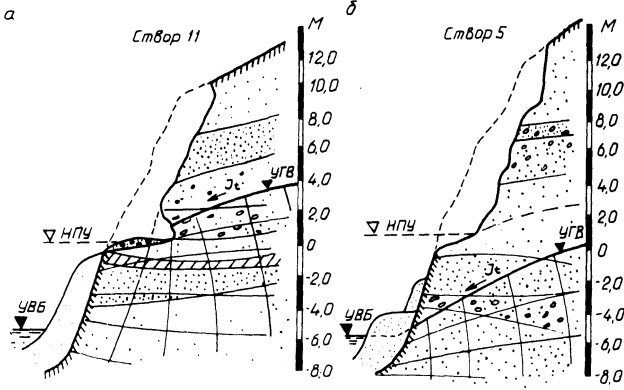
Разрушение береговой отмели под действием грунтовых вод на водохранилище Волковичи:
